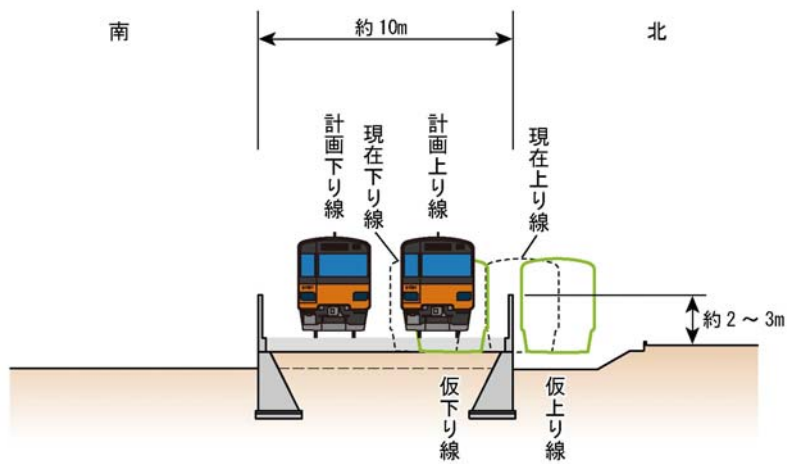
(1) 一般部標準断面図(擁壁区間(a-a断面))
